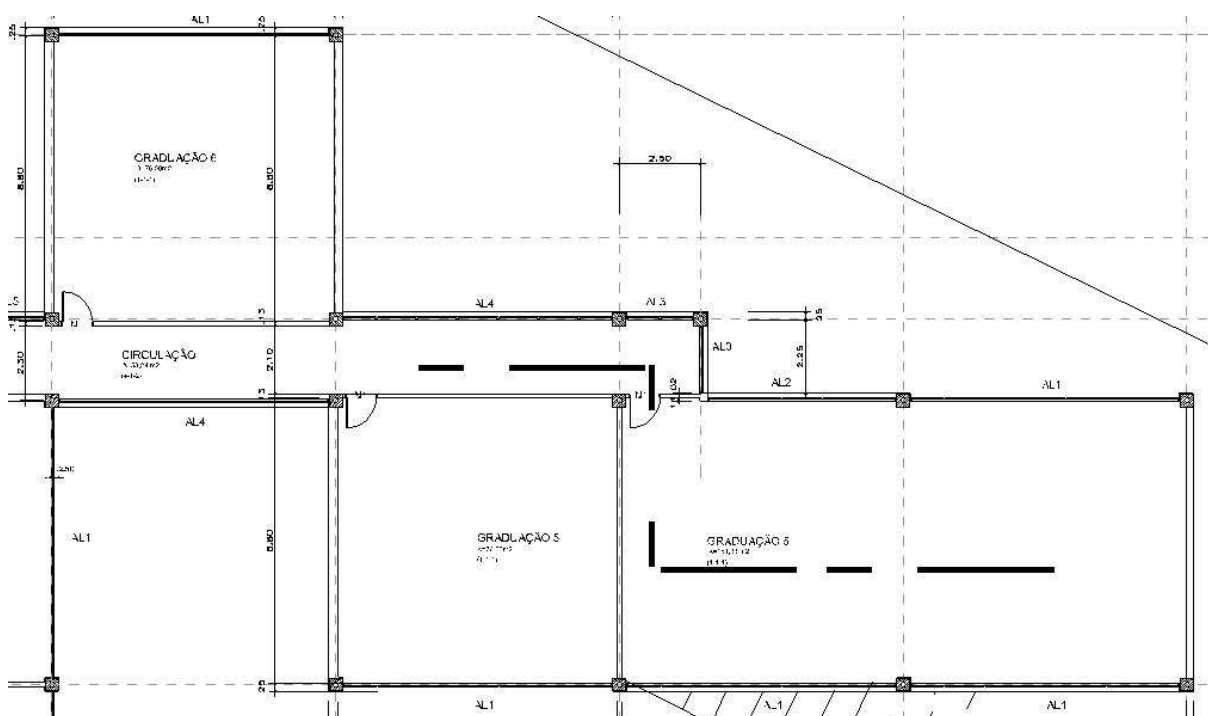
PLANTA BAIXA DA OBRA 2
